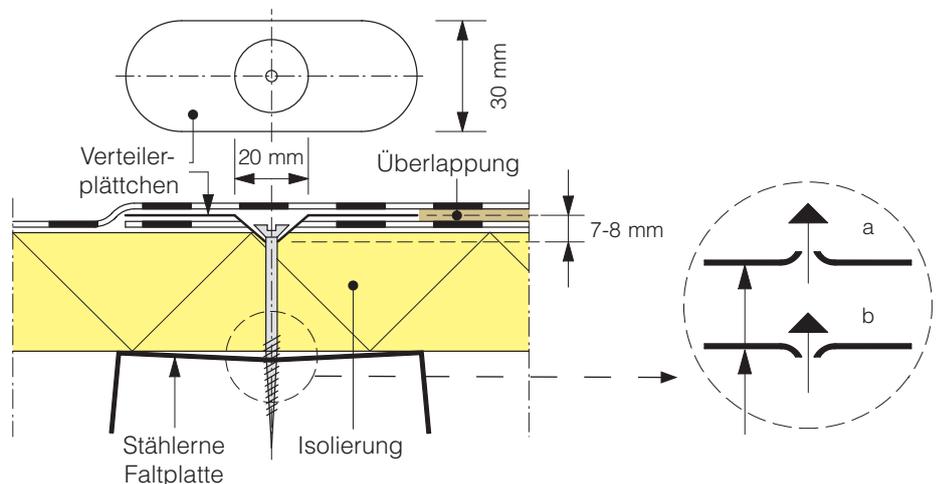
Eindrücken des Schraubkopfs in das Verteilerplättchen (links) und Verformung der profilierten Stahlplatte in Höhe einer Befestigung (rechts, der Pfeil zeigt die Ablöserichtung bei stürmischem Wetter).
